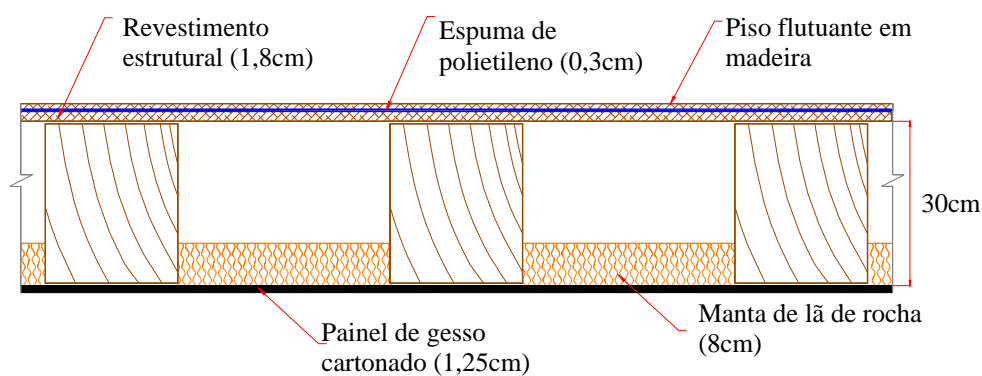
Pavimento de estrutura descontínua em madeira com isolante e piso flutuante sobre revestimento estrutural (Pav15)
